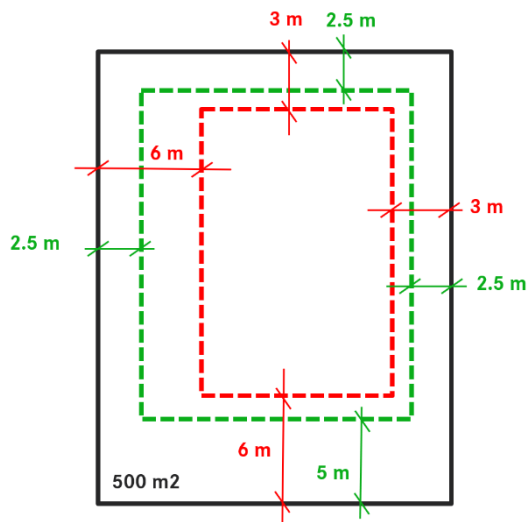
Schema mit bisherigen Grenzabständen in der Wohnzone 2 (rot) und neuen Abständen (grün). Der bebaubare Bereich und damit der Spielraum für die Entwicklung einer Parzelle erhöhen sich entsprechend (+33%).
